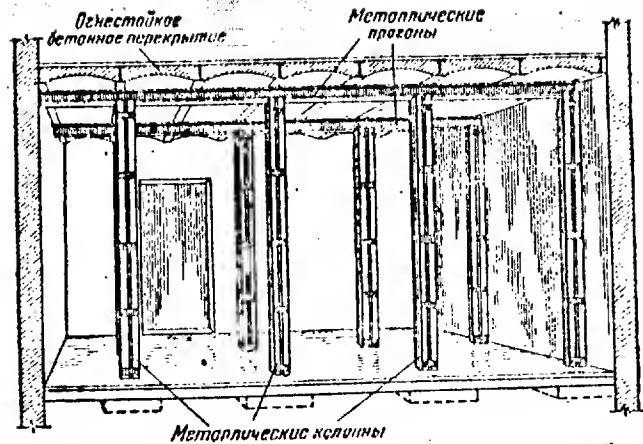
Усиление перекрытия под убежищем (Reinforcement for Shelter Ceiling)
